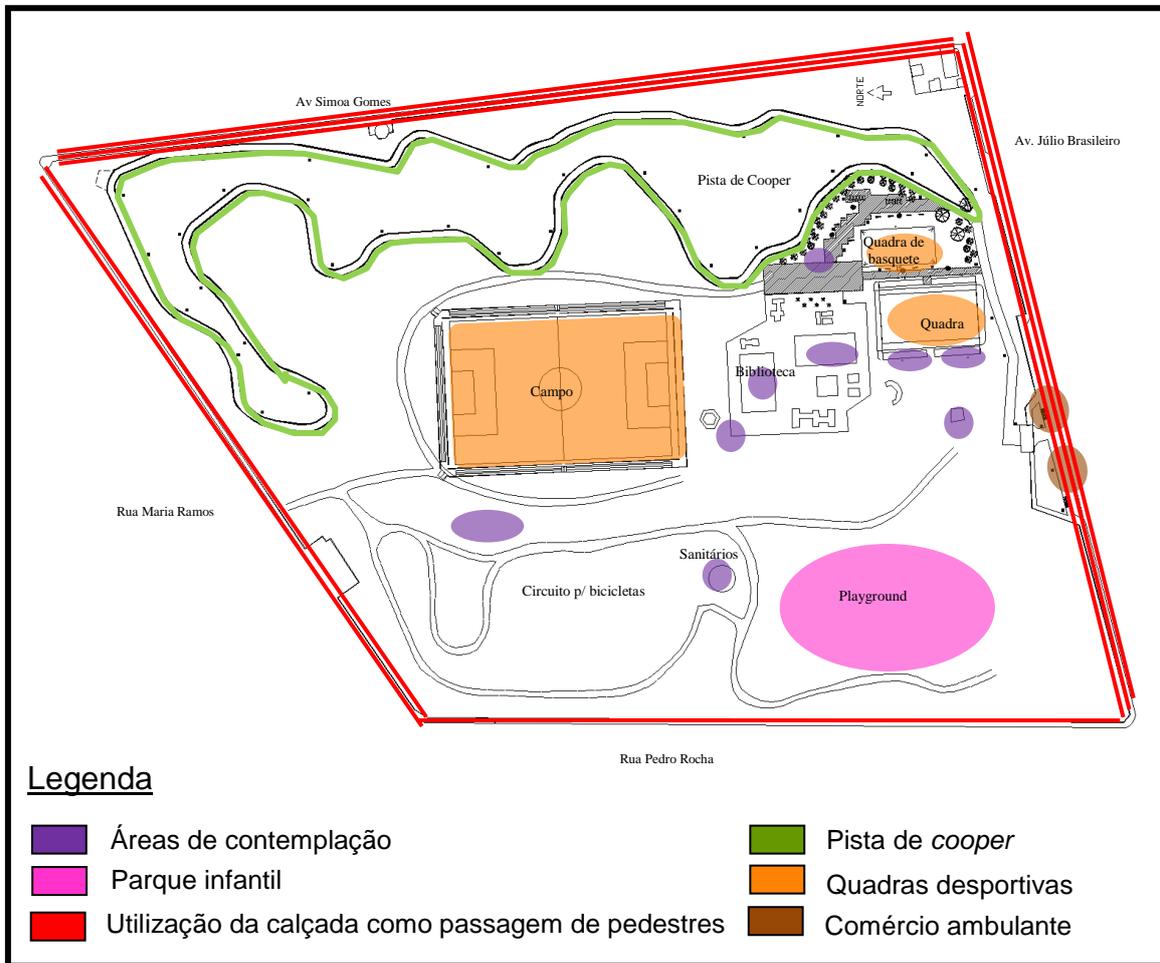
Planta Baixa da Academia da Cidade de Garanhuns.
